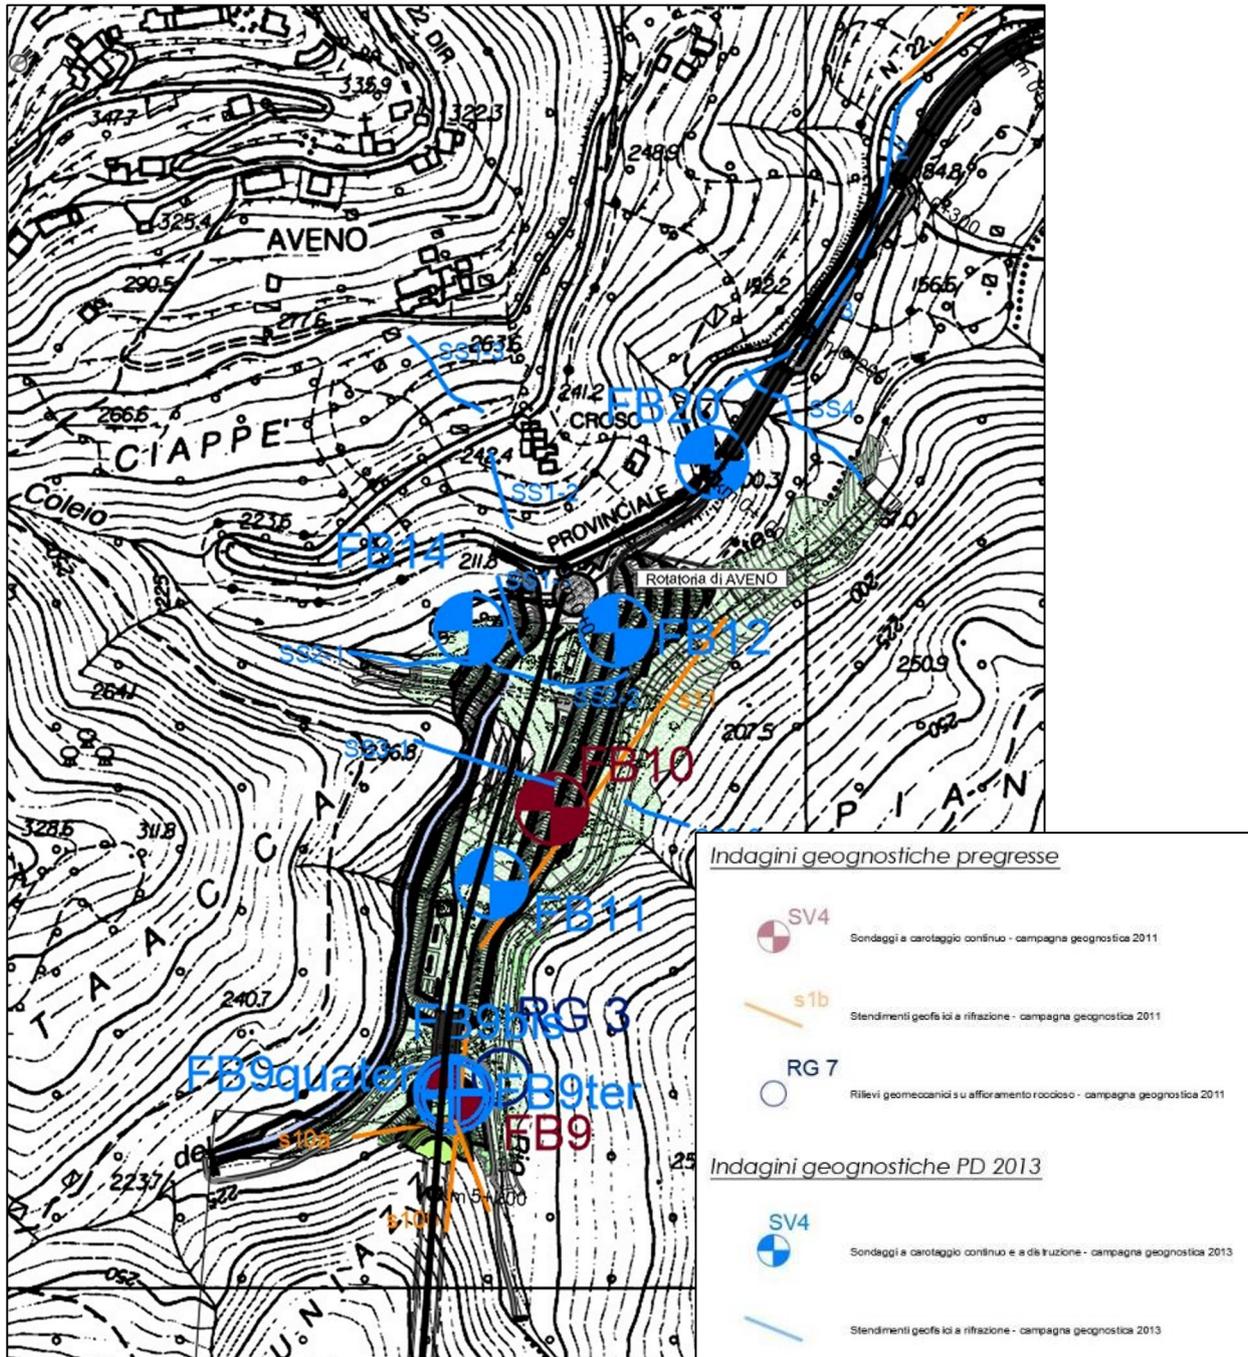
Stralcio planimetrico con l'ubicazione delle indagini
